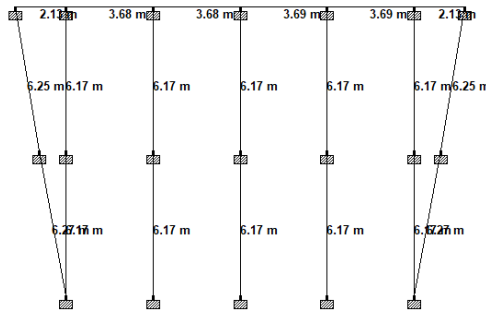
Vista Planta de la Estructura con Dimensiones
